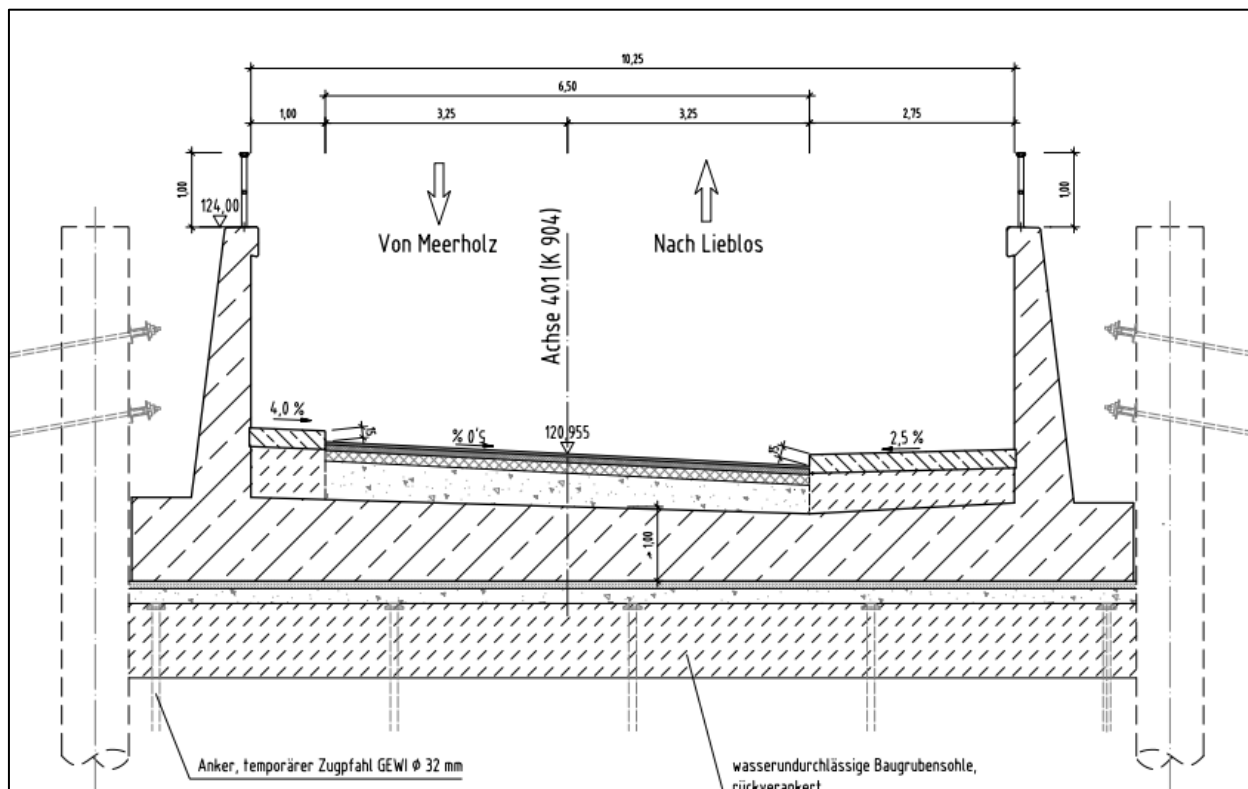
Querschnitt Variante 2 im Bereich Trogstrecke und Unterführung DB und Bahnstraße
